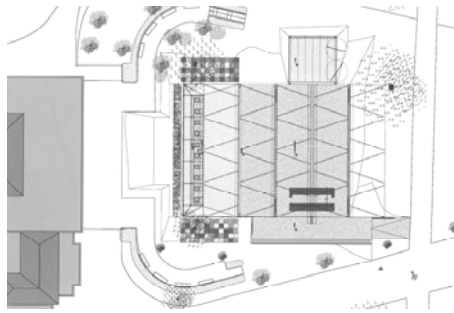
Planta de implantação, pavilhão de Jean Nouvel, 2010.
